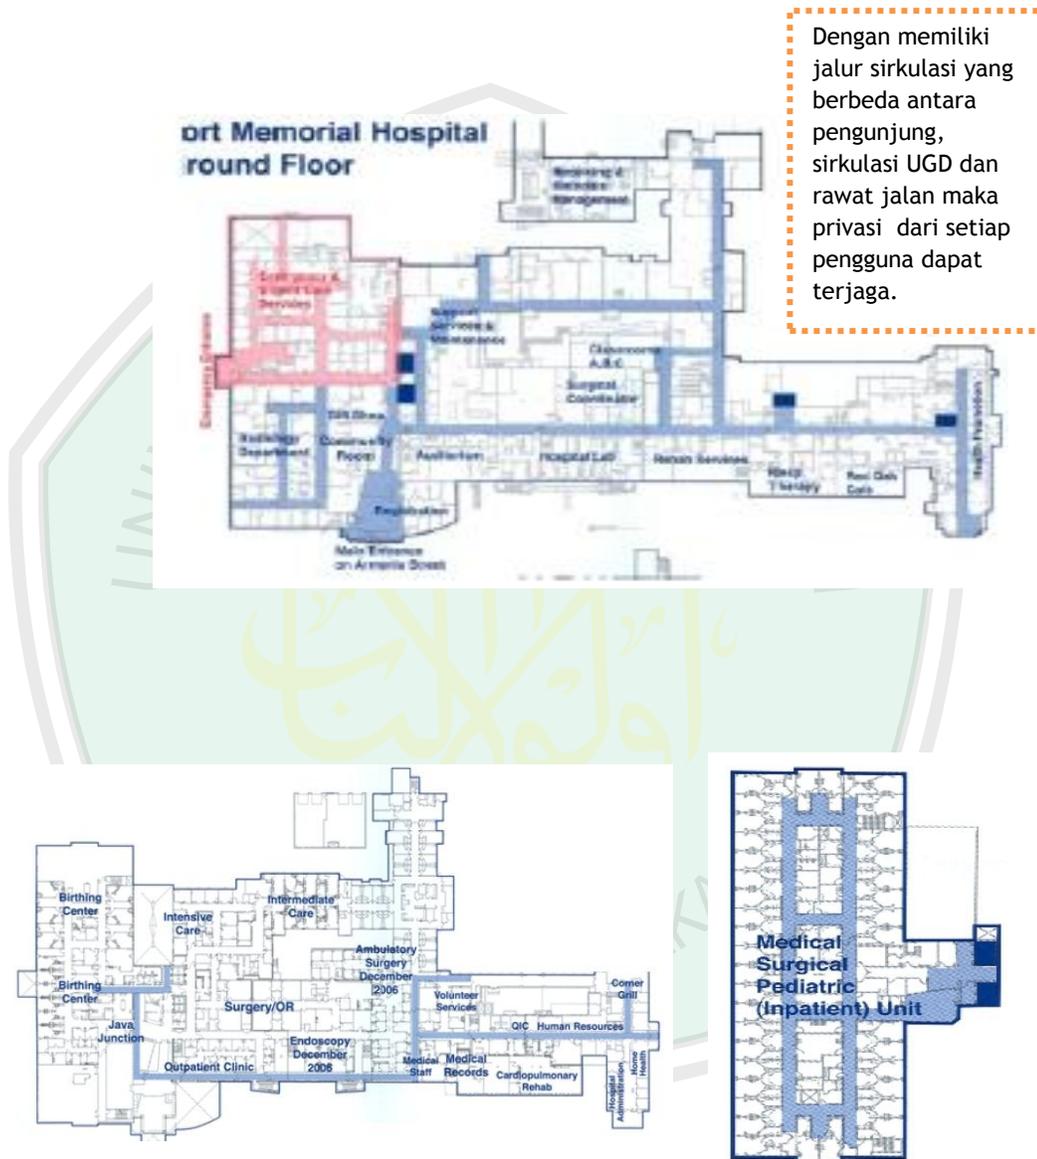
Denah Sirkulasi Lantai 2 Fort HealthCare
